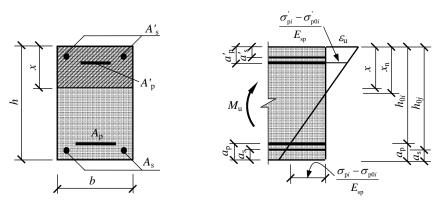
预应力混凝土受弯构件应变和受压区高度的关系
